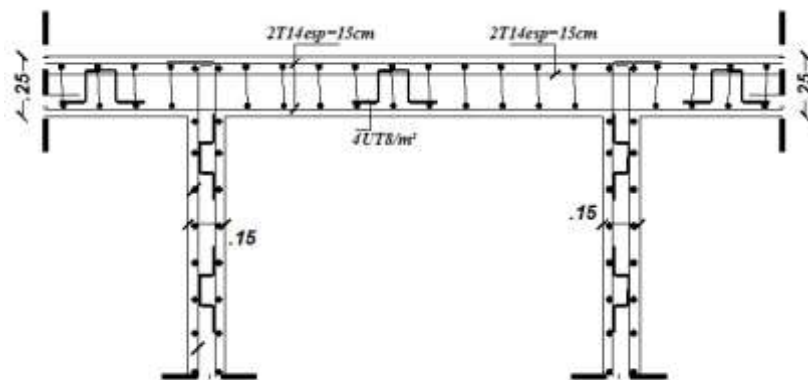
Ferrailage de dalle pleine eps=25 cm
